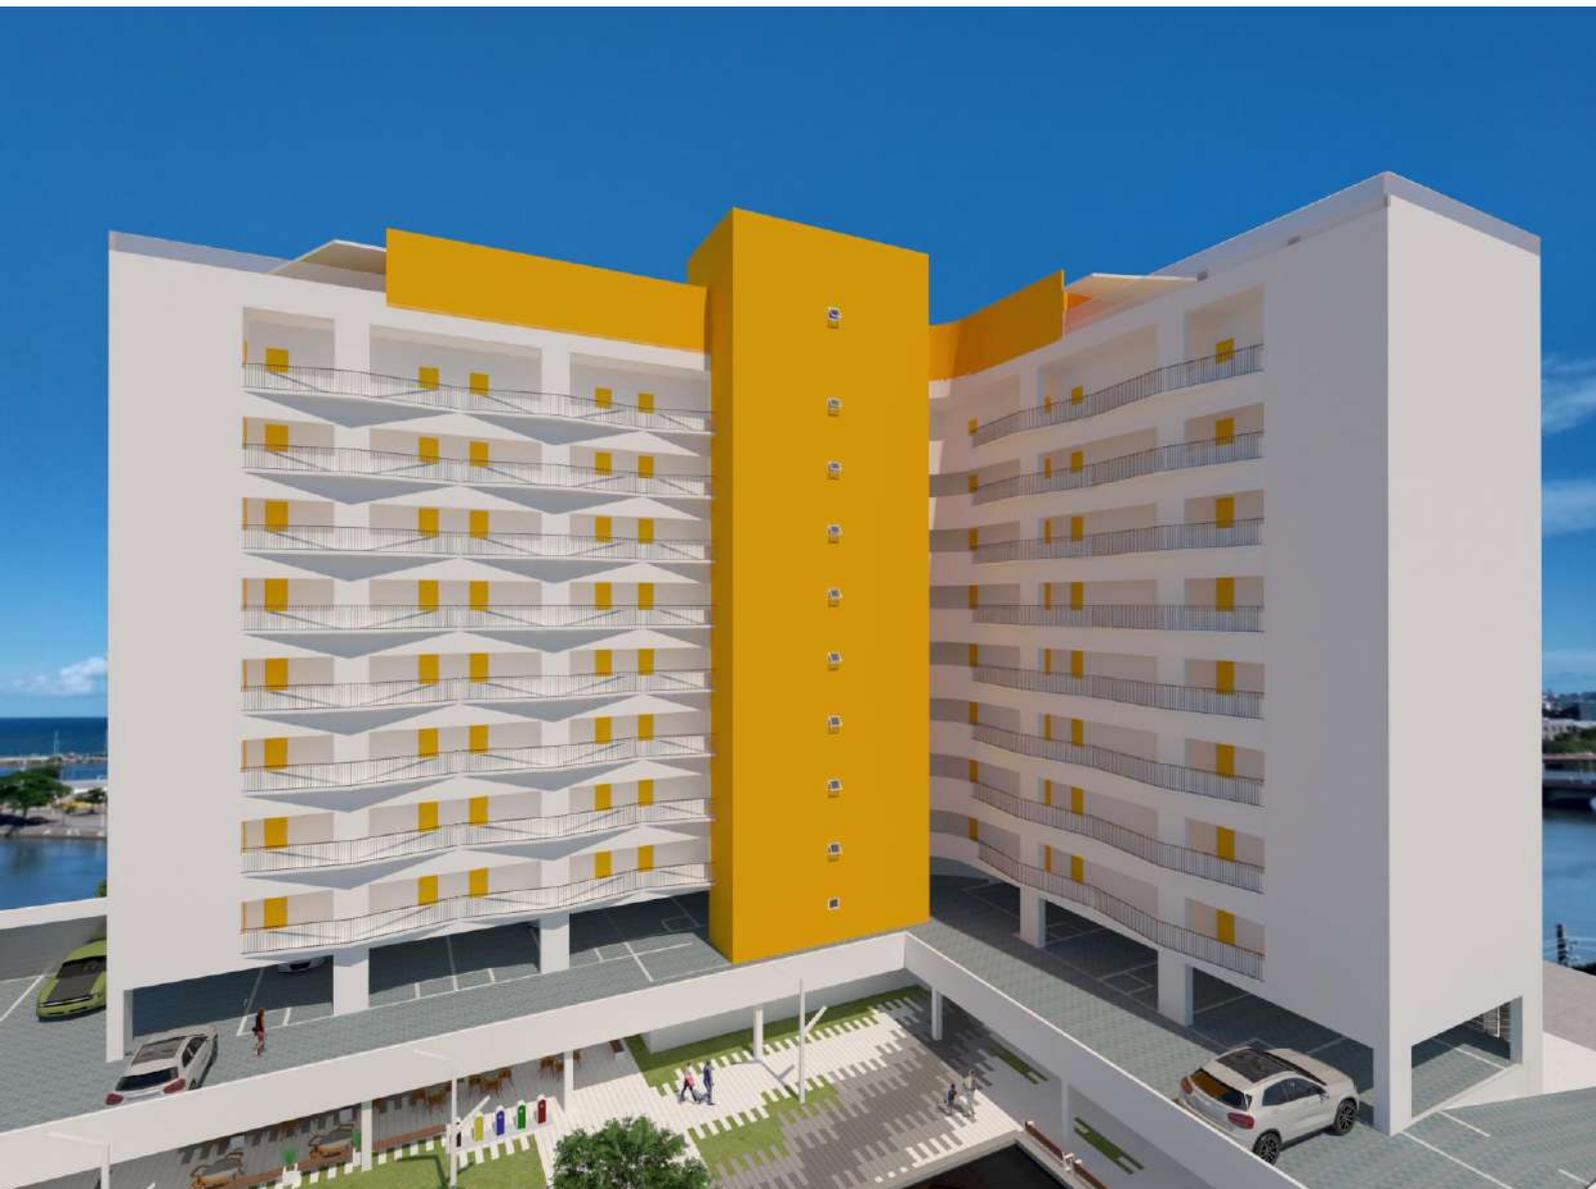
Fachada ativa. (Fonte: Autoral, 2022)
